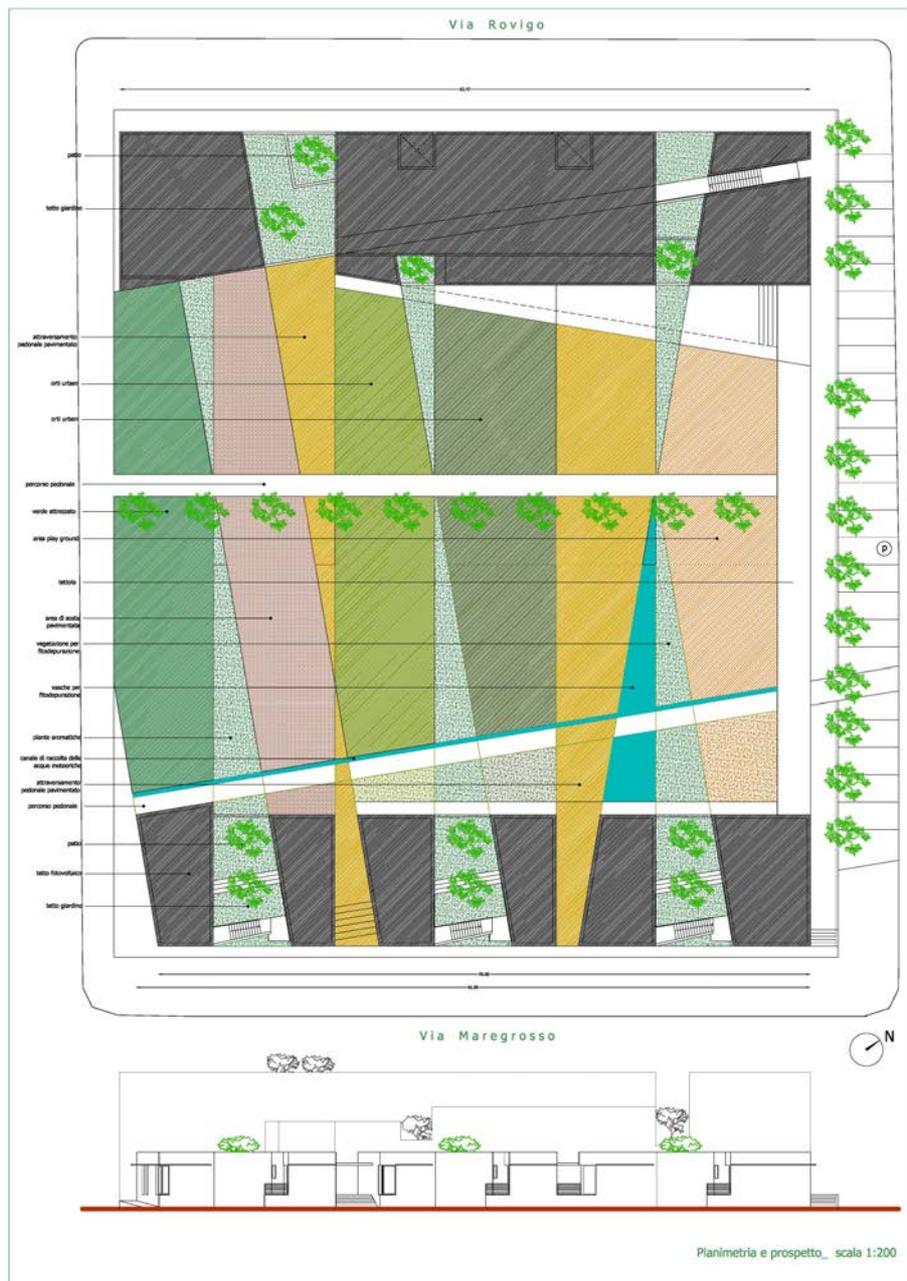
| Prospetto e Planimetria coperture - scala 1:200.
